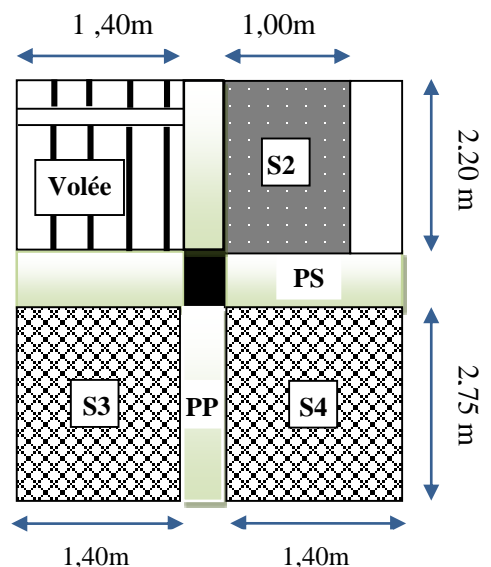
Surface qui revient au poteau (C4) niveau d'étage courant
